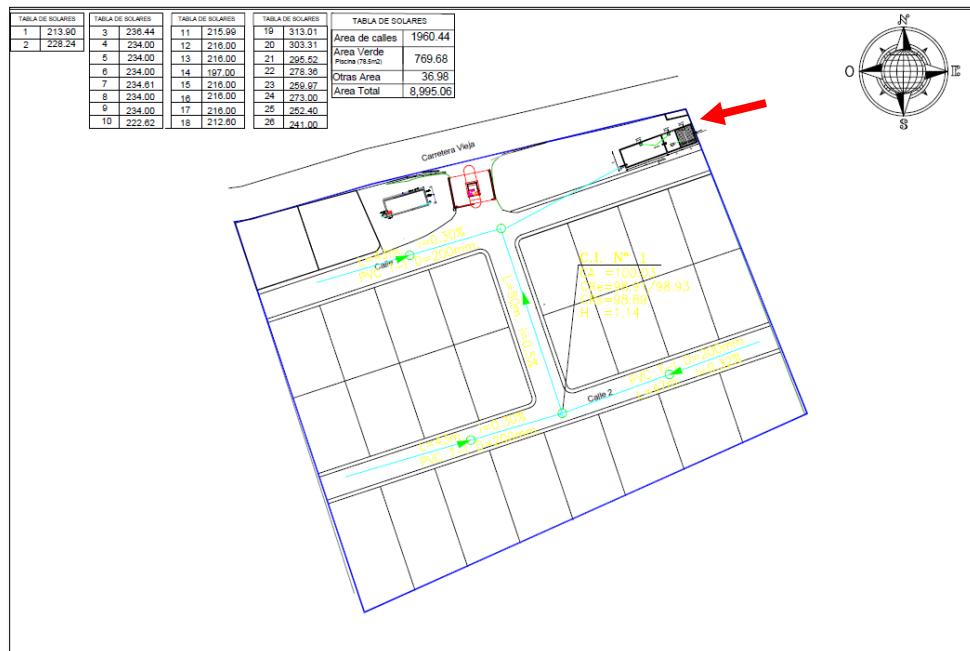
Lugar en donde se ubicará la planta de tratamiento.
